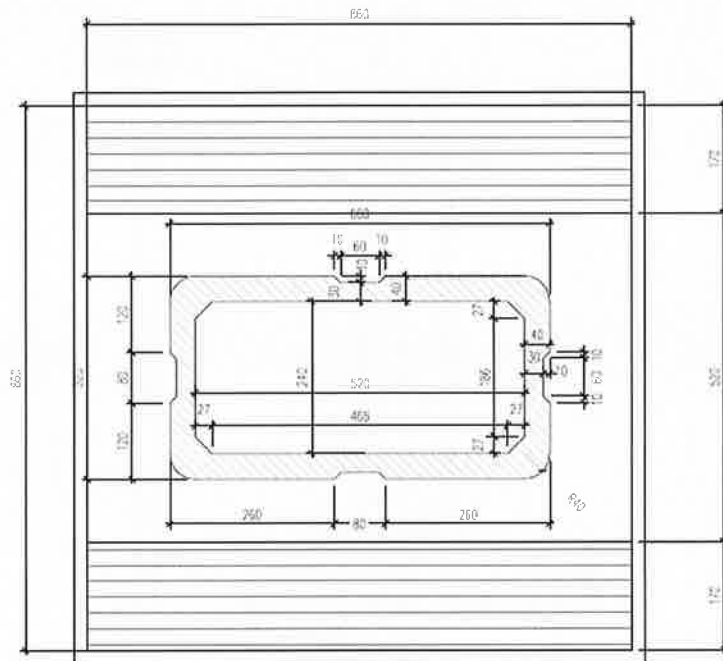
Pianta fondazioni 8.6x8.6x2.3m, Bonorva VI01
